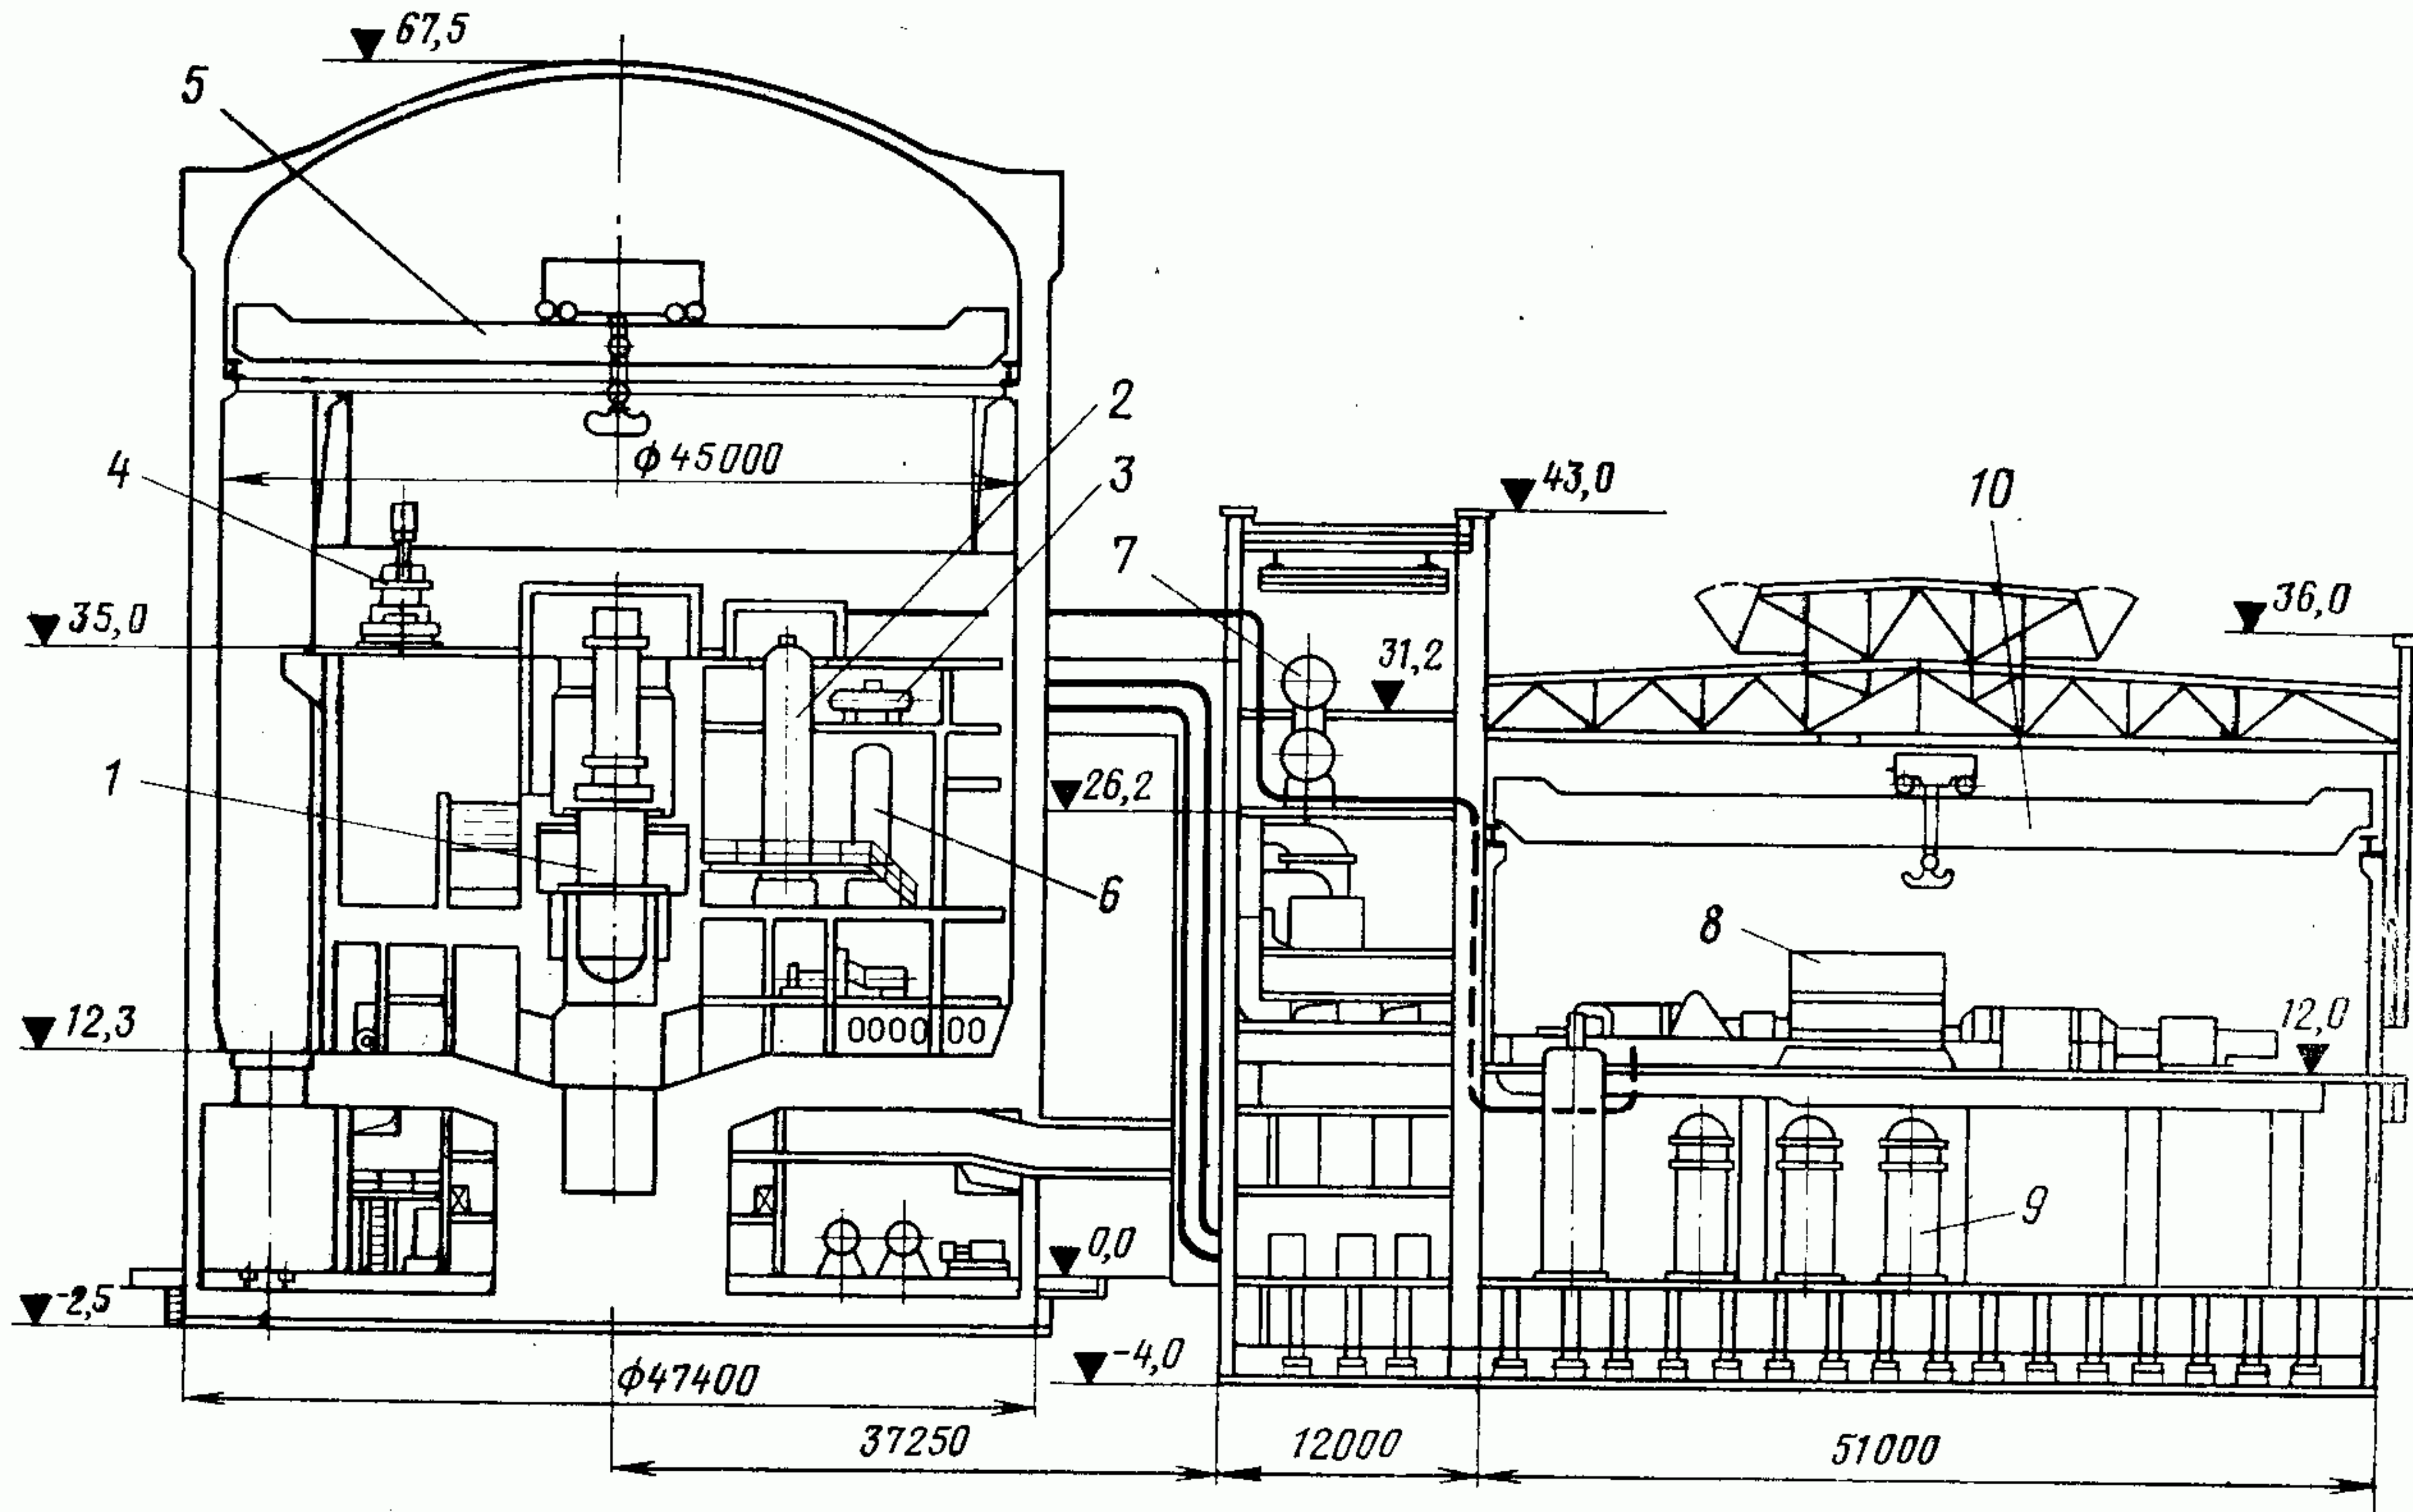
Поперечный разрез главного корпуса АЭС с ВВЭР-1000 и двумя турбоагрегатами по 500 МВт.
